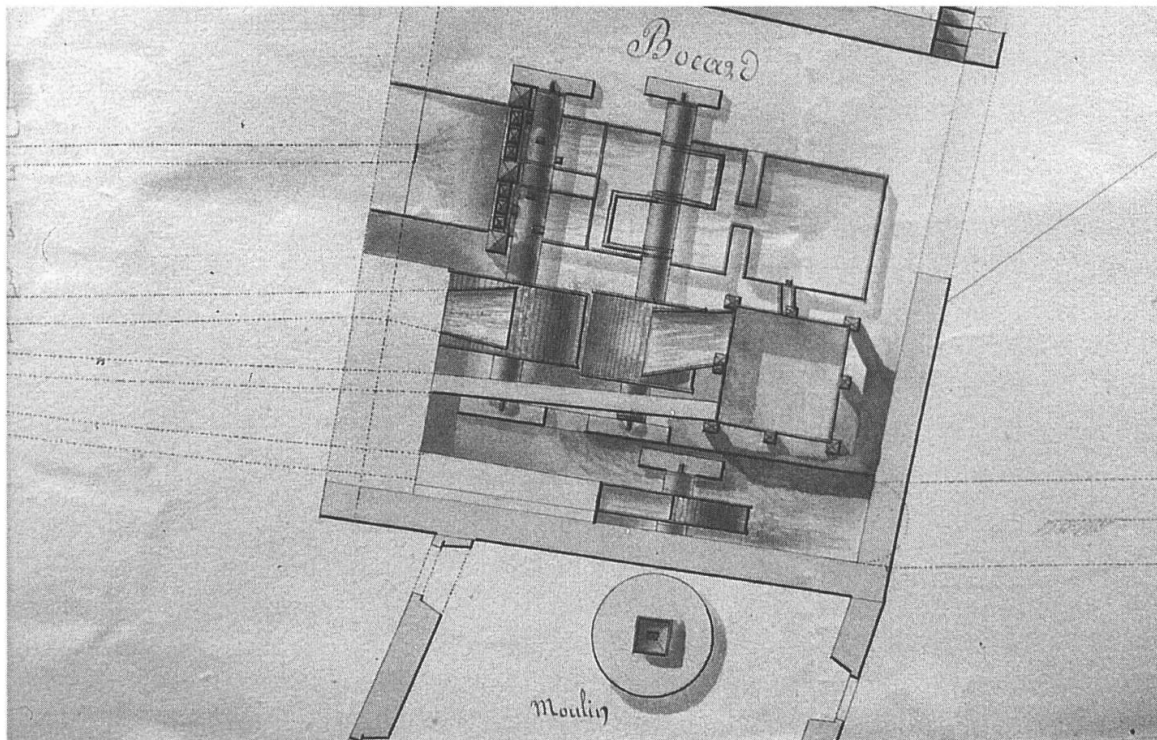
Patouillet à roue hydraulique à une huche, attaché au bâtiment du haut fourneau de Marante (1818) Haute-Marne. ANF14 4522. Une installation identique a vraisemblablement été mise en place à Montagney.
